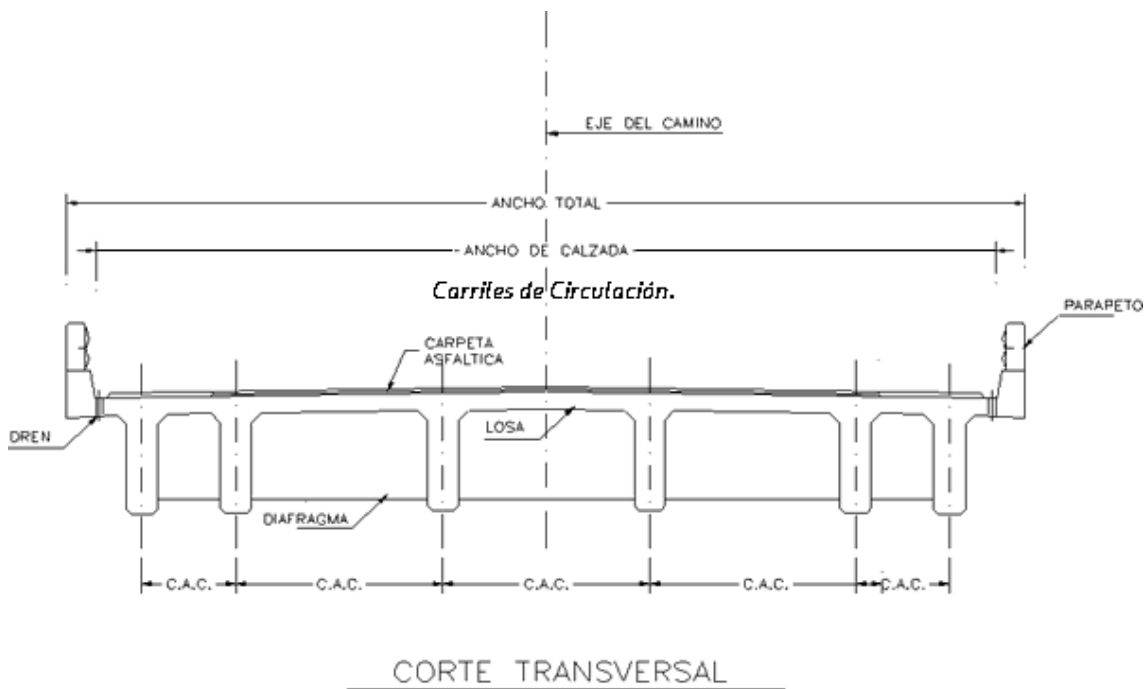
Partes que integran un puente, Corte. Fuente: www.construaprende.com
